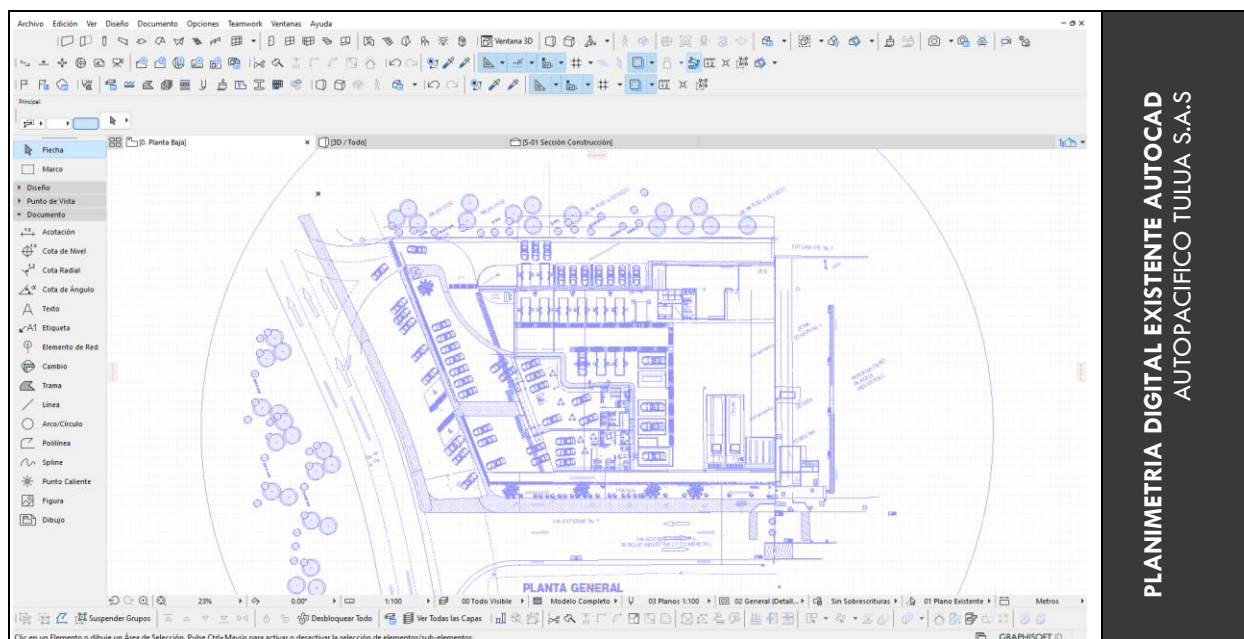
Planimetría digital existente AutoCAD Autopacífico Tuluá S.A.S
